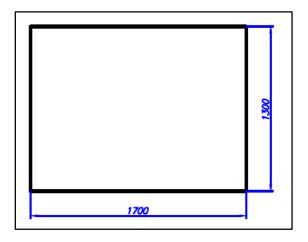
6 Dimensiones placa base. Fuente Autores.
